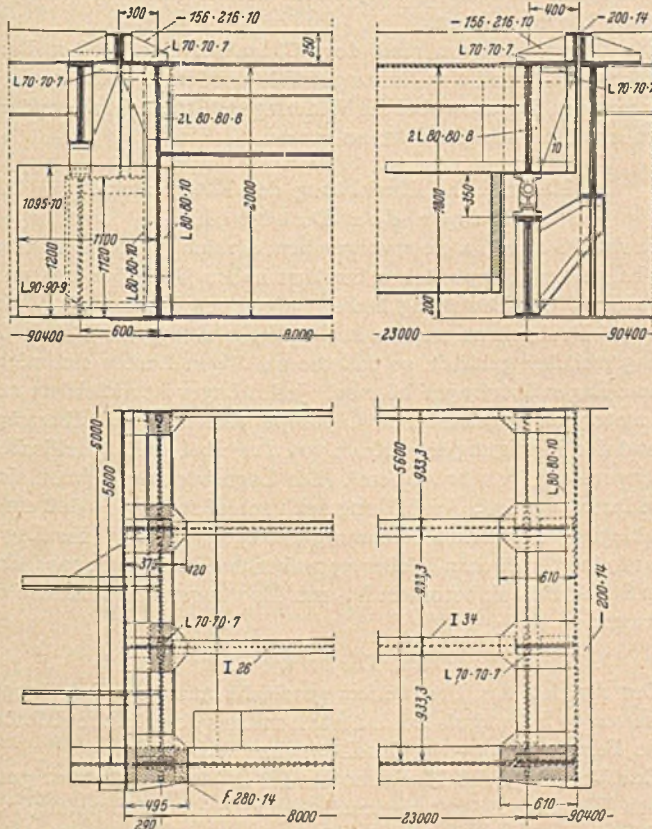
Fahrbahnabschlüsse an den Klappenenden. Aufrisse, Grundrisse.
